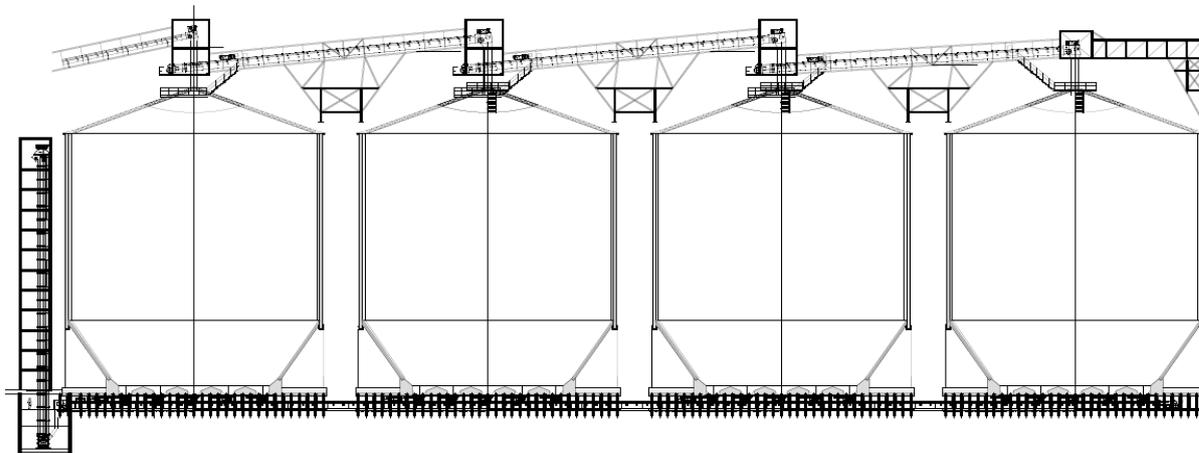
Fileira de silos verticais de concreto – 15.000 toneladas cada
